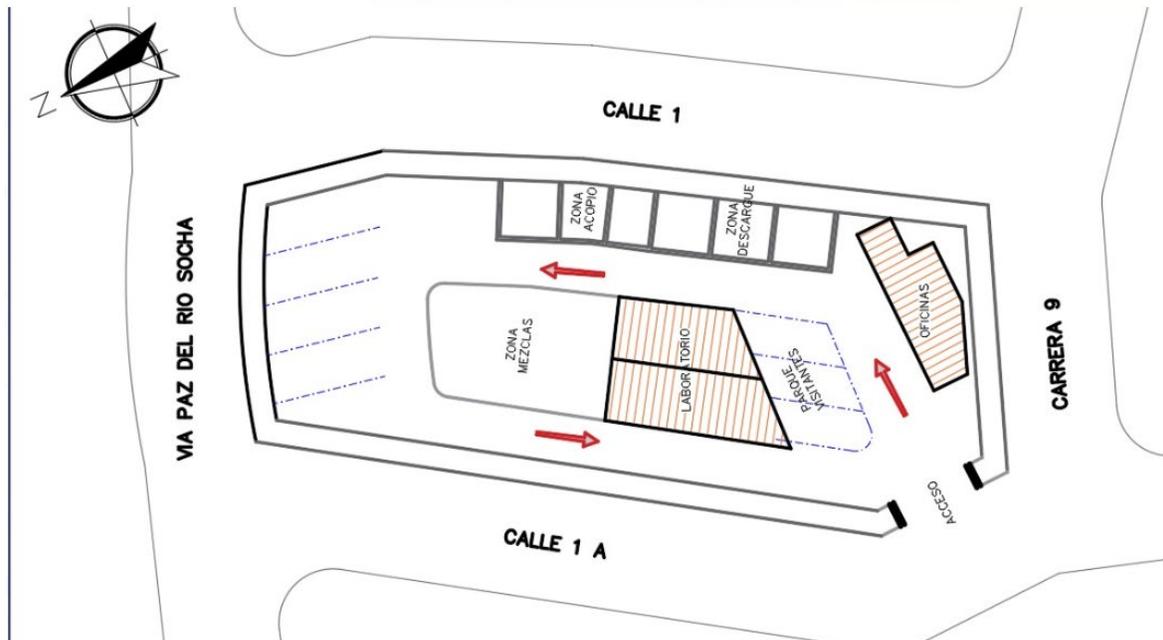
Plano de distribución de zonas de la planta de producción. Fuente: Propia.
